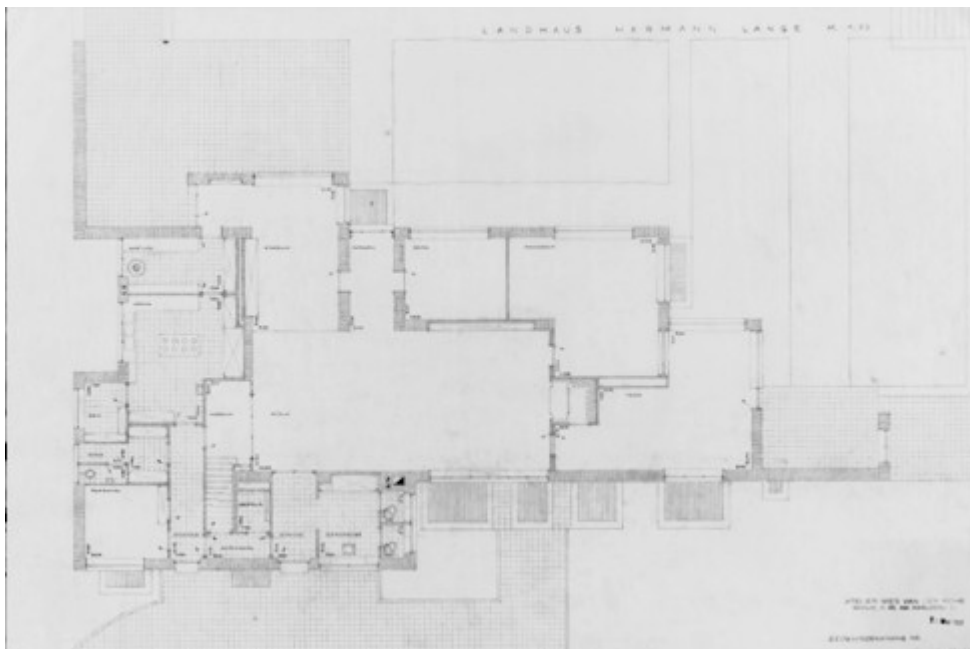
Planta baixa pavimento térreo, Casa Lange, 1927
